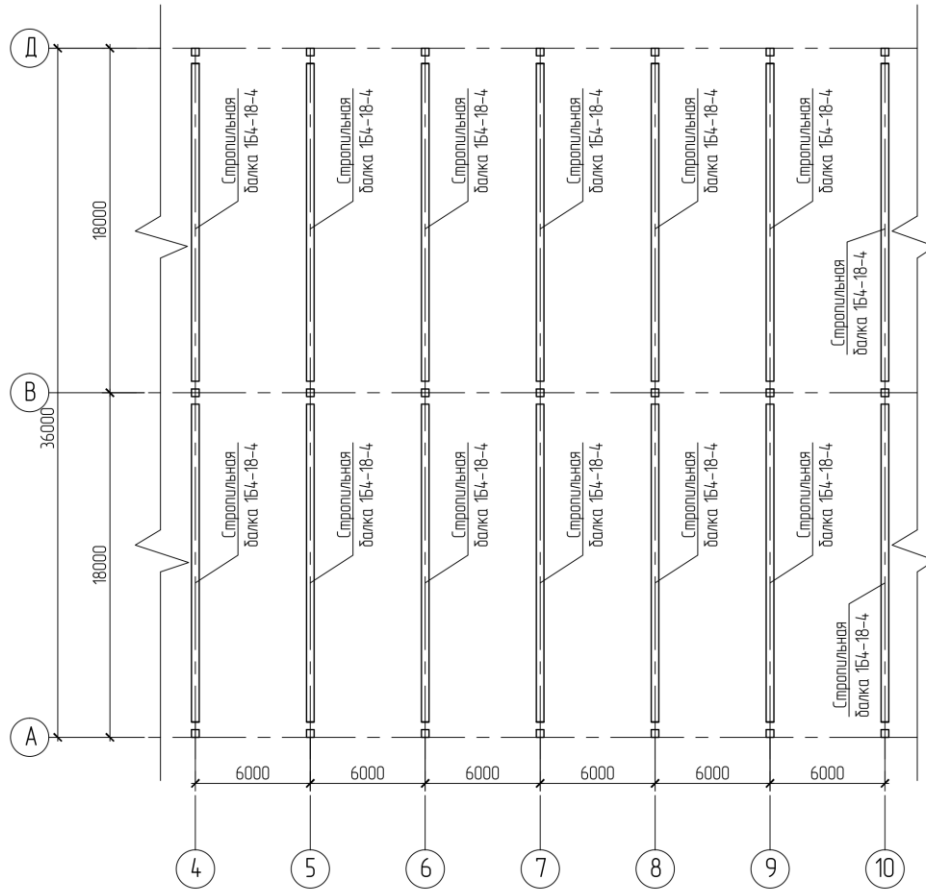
План расположения стропильных балок покрытия в осях А-Д/4-10
